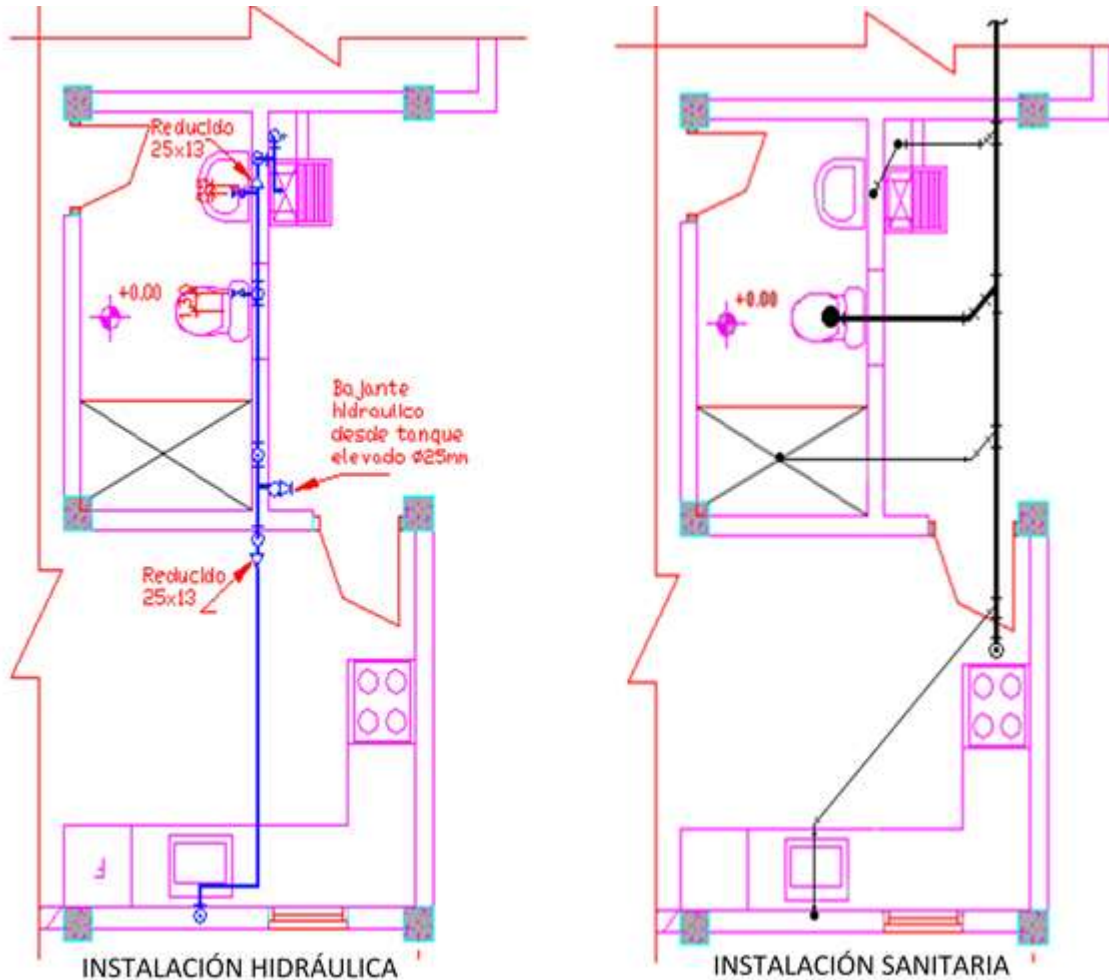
Plano de vista en planta de instalaciones hidrosanitarias
